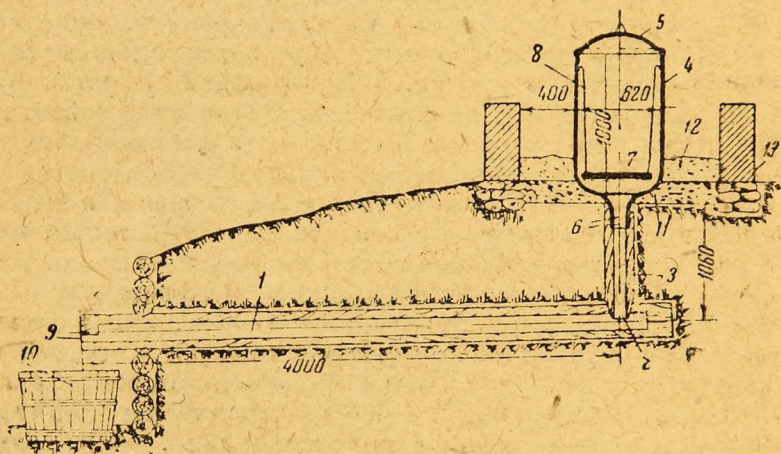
Дегтекурная установка с открытой корчагой: 1—колода, 2—отверстие для стока дегтя в колоду, 3—деревянный соединительный патрубок, 4—корчага, 5—крышка корчаги, 6—отверстие в корчаге для стока дегтя, 7—решотка для бересты, 8—тяги, 9—сточное отверстие, 10—сборный чан, 11—слой глины, 12—слой песка, 13—кирпичная стенка
